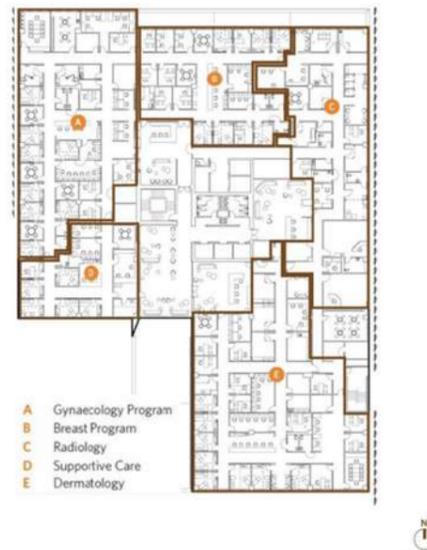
Planta do primeiro pavimento - Centro do Câncer
